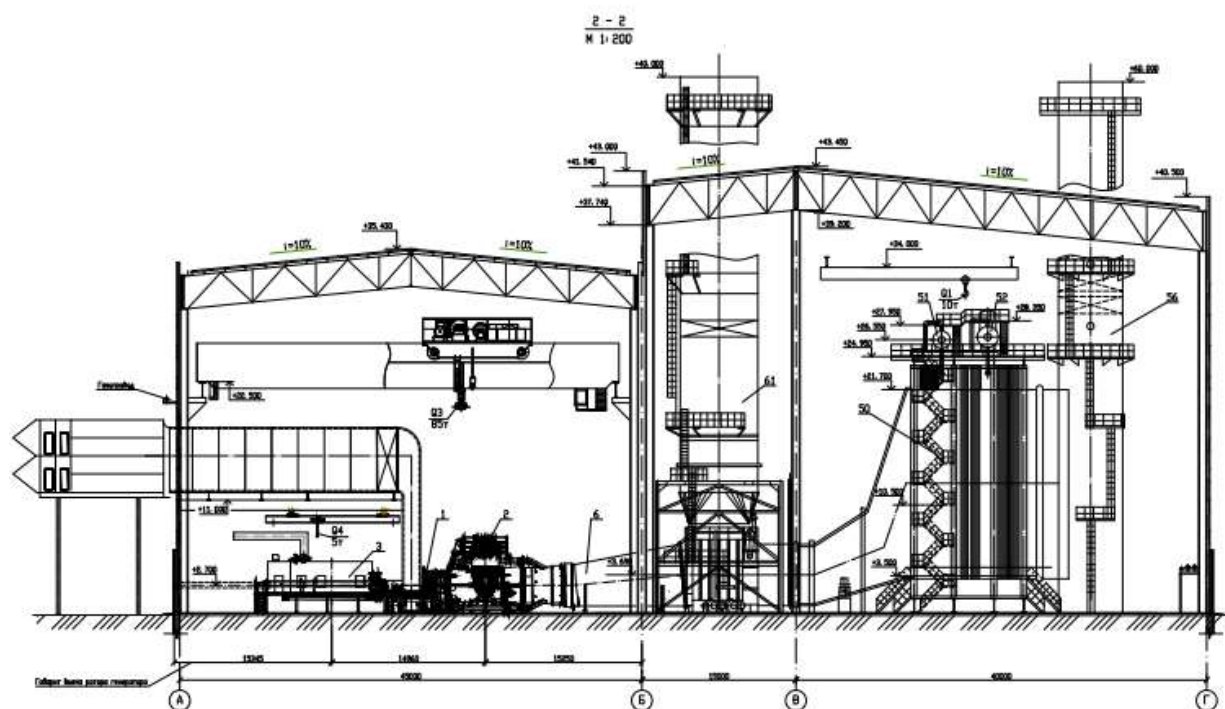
В.4.2. Компоновка главного корпуса ГТ-ТЭЦ. Разрез
